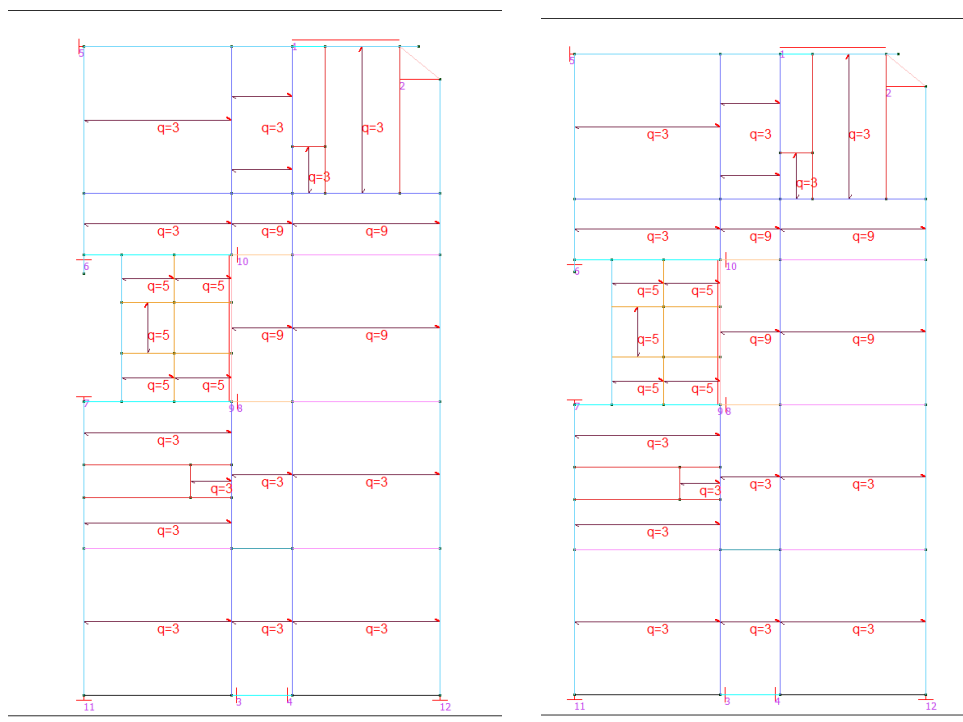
pianta solaio con indicazione tipologia solaio – pianta piano primo e secondo
